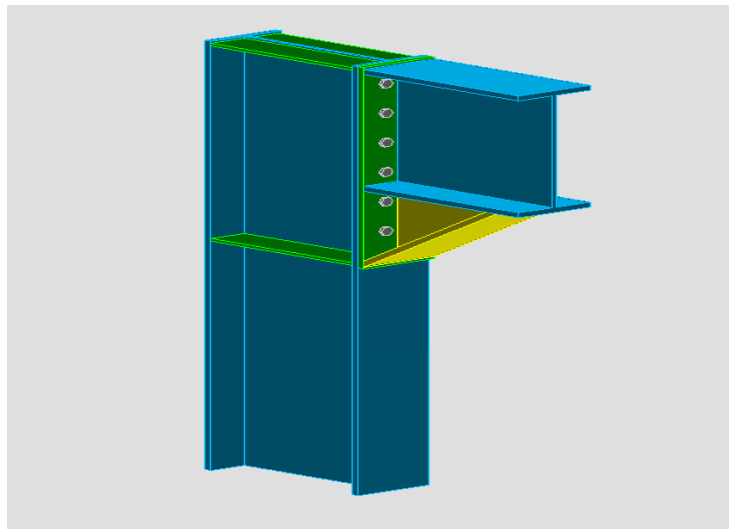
Assemblage poteau-poutre HEA700- HEA550
